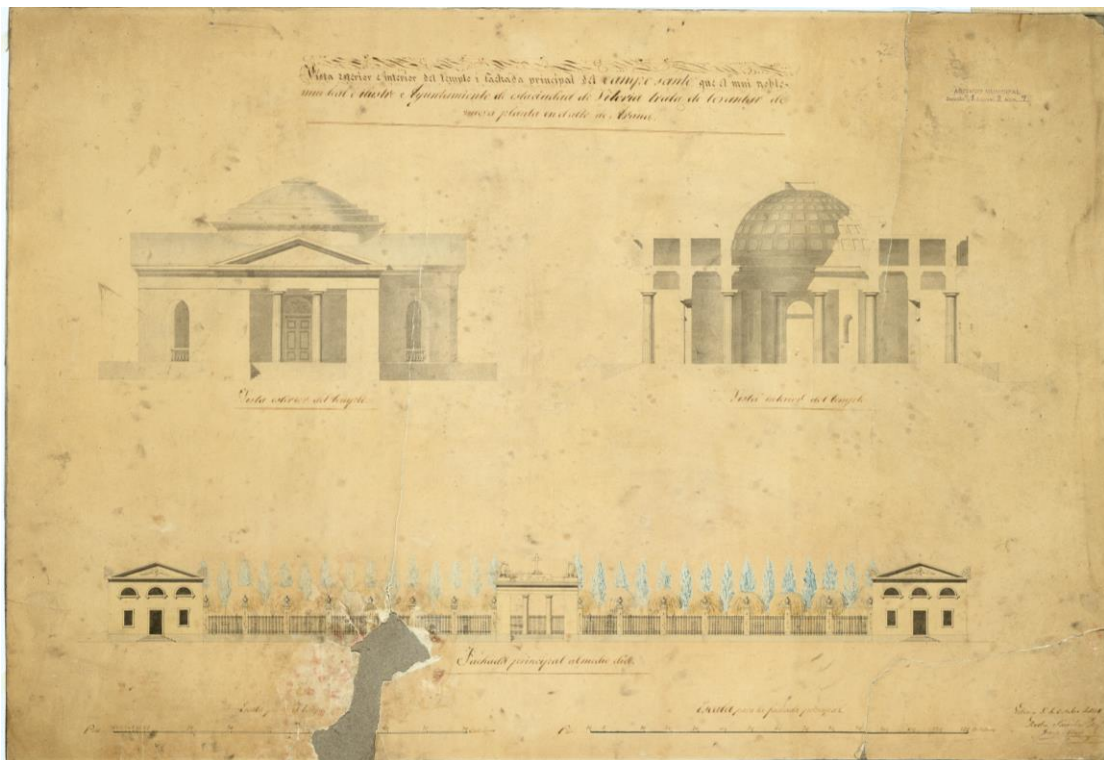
Alzado del proyecto de Saracibar, 1849. Foto: AMV.
